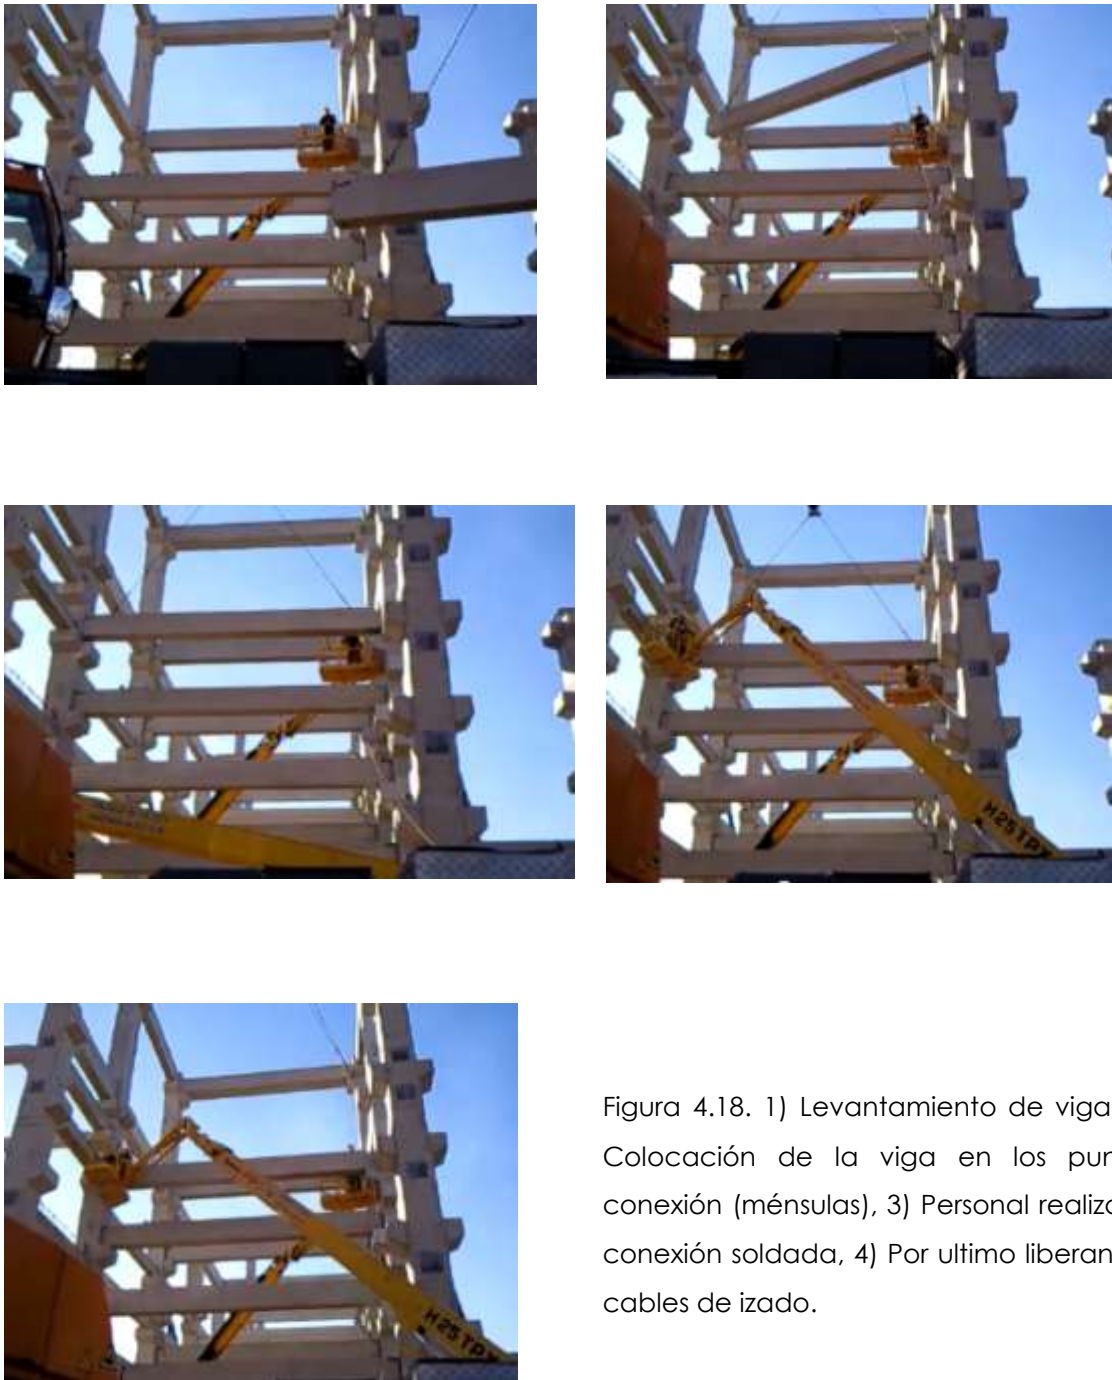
1) Levantamiento de viga, 2) Colocación de la viga en los puntos conexión (ménsulas), 3) Personal realiza la conexión soldada, 4) Por ultimo liberan los cables de izado.
